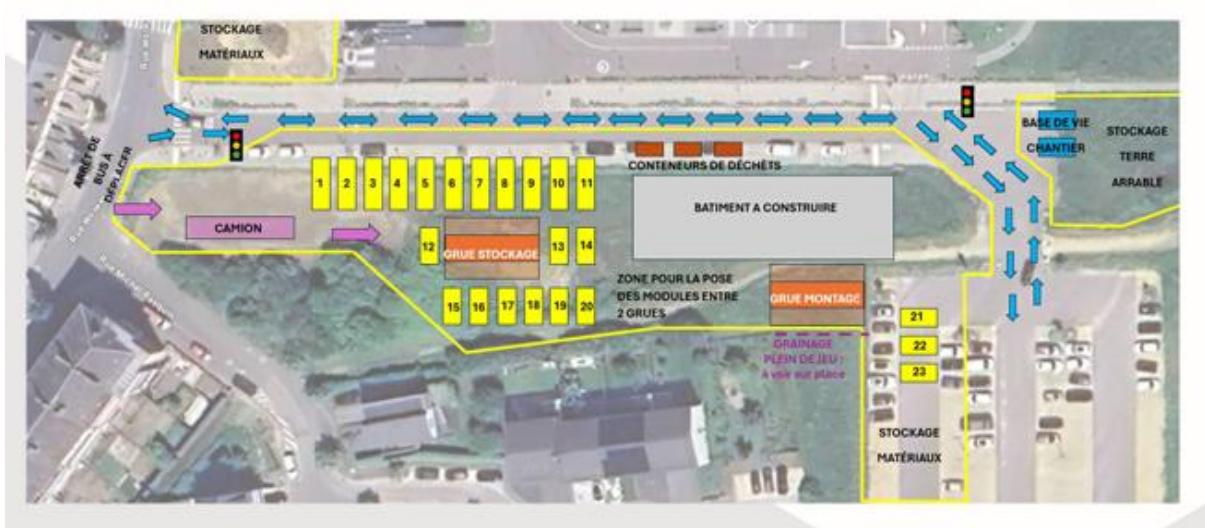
Plan de planification du chantier "ecole de Um bock" de Degotte
